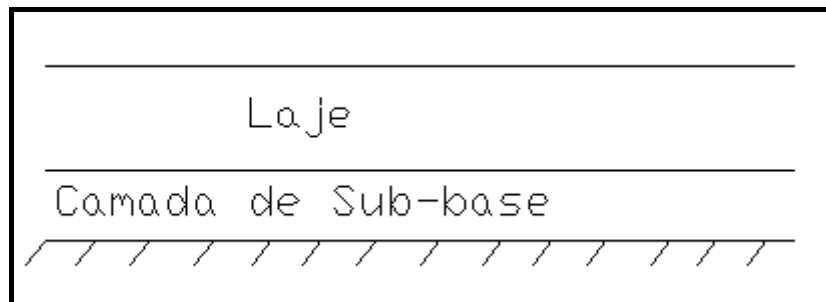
Esquema estrutural de um Pavimento Rígido corrente
